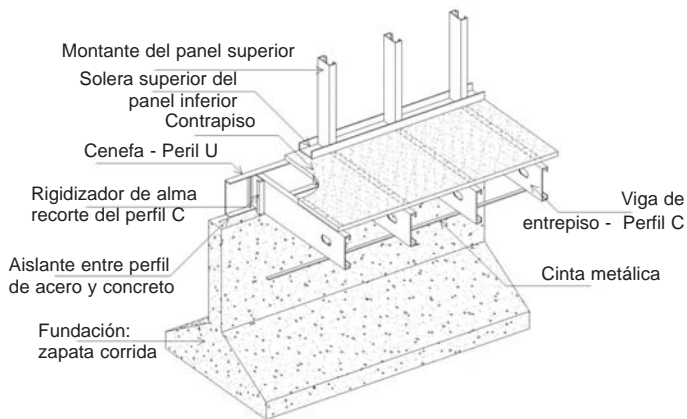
Entrepiso en Steel Framing apoyado sobre fundación tipo zapata corrida
